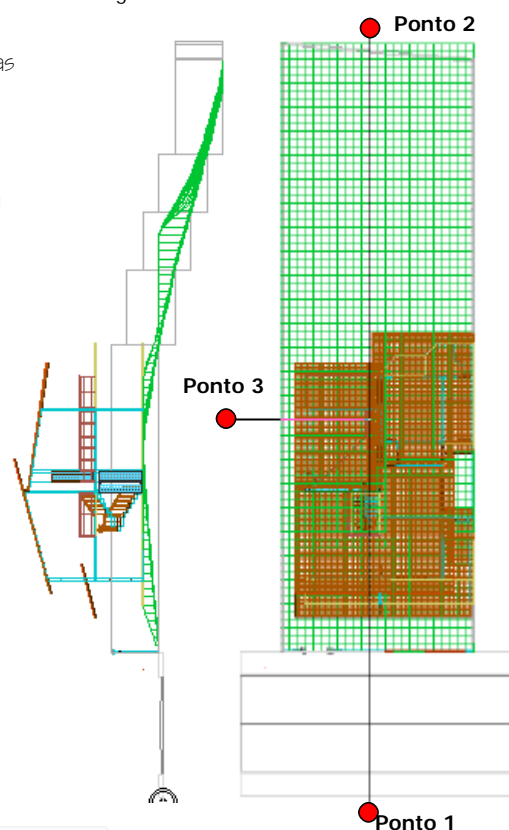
Fachada gerada e sequência do comando para geração de Cortes
